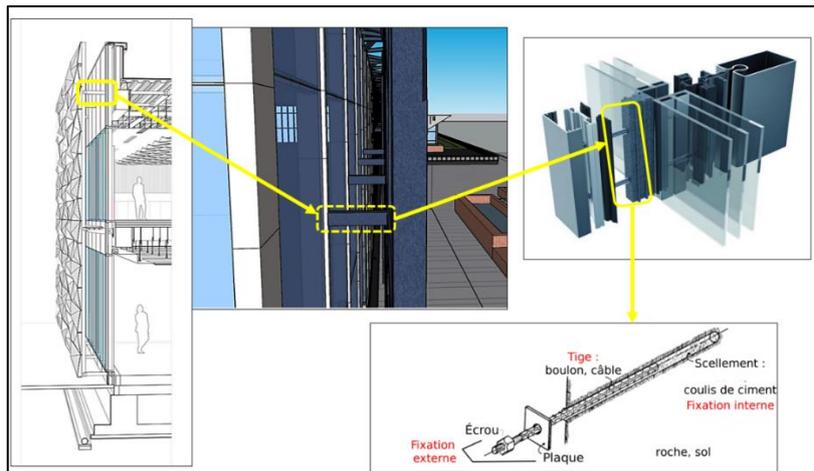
Fixation de la résille de façade au mur rideau.⁸⁰
